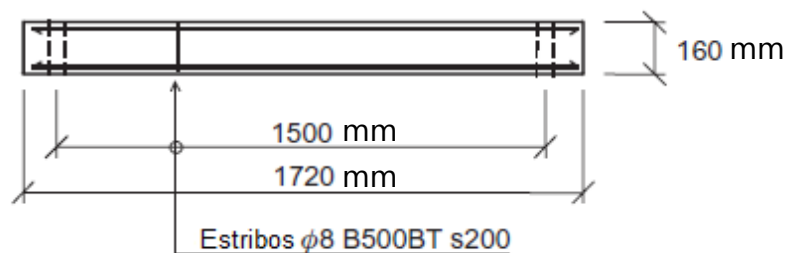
Secção longitudinal, viga B100(12) e B140. Adaptado de [10].
